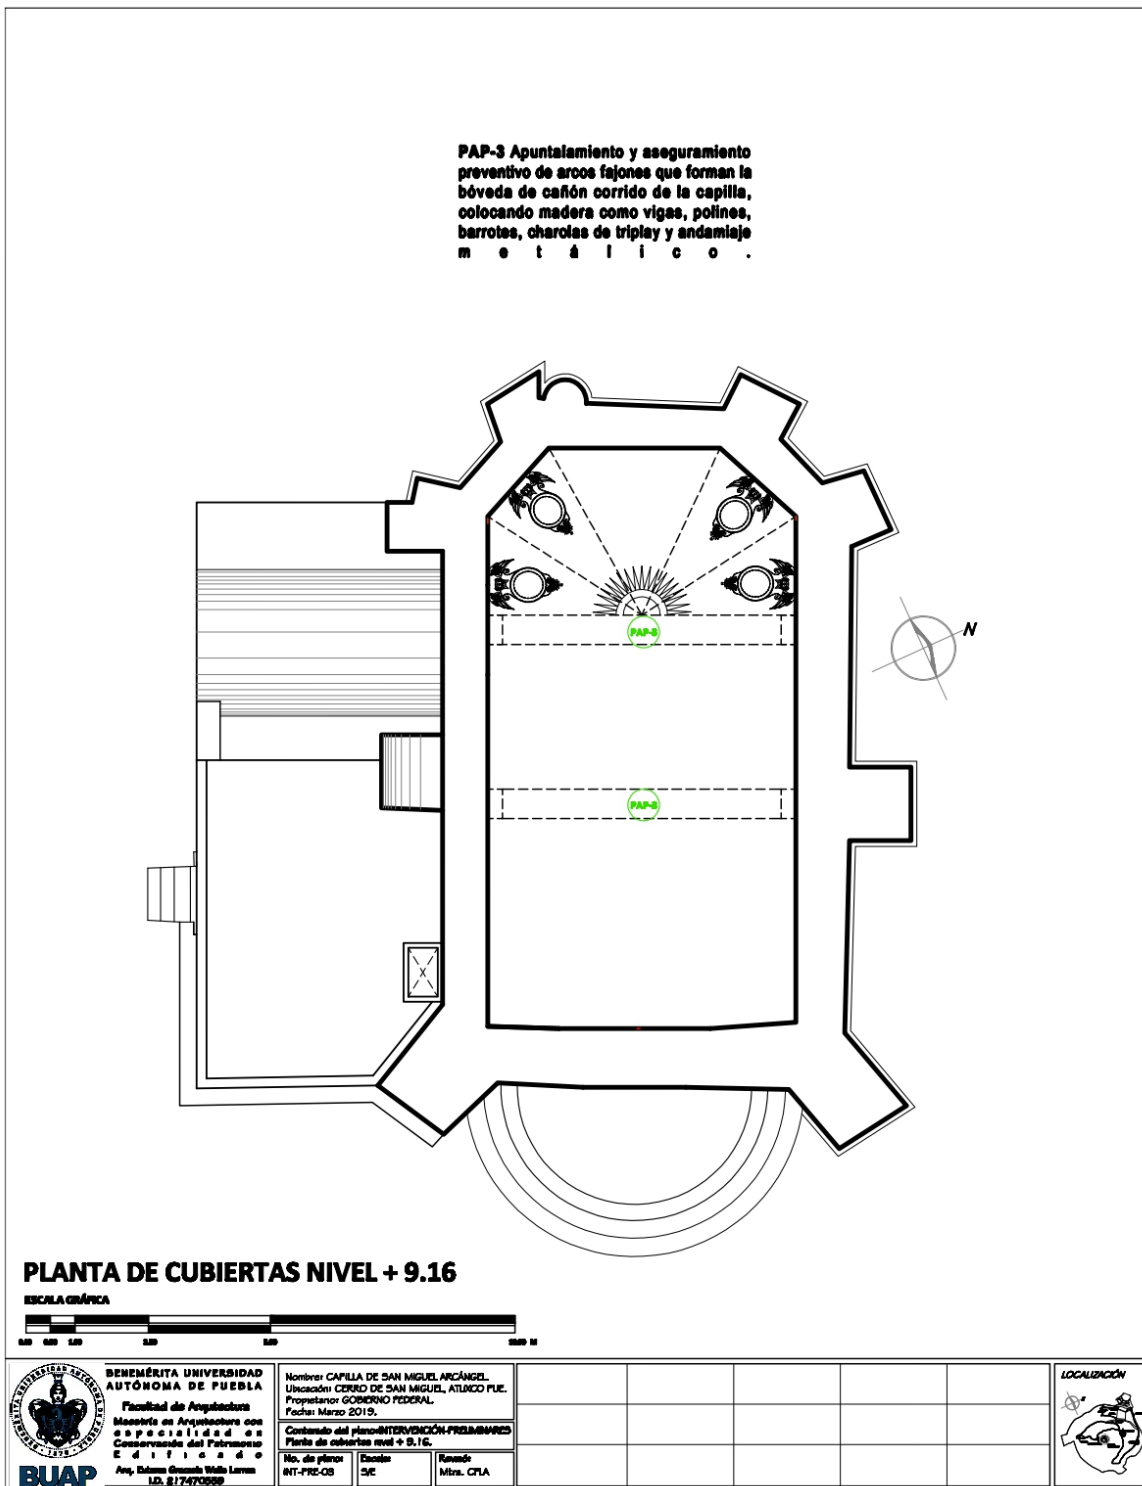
Plano 4 de intervención con acciones preliminares en la cubierta del templo.
